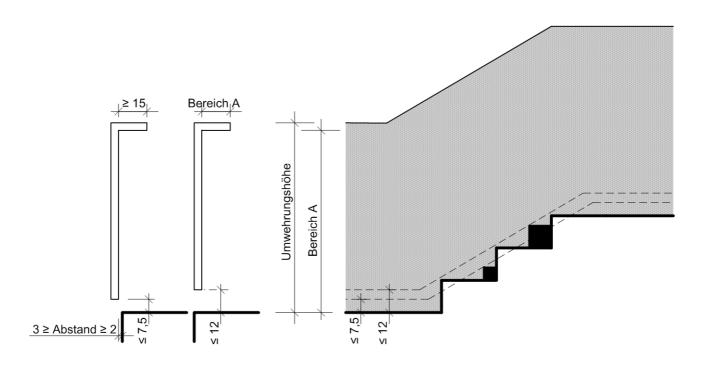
Beispiel für Umwehrung über Treppenlauf und Podest (Maße in cm) mit innen überstehender Geländerkante
